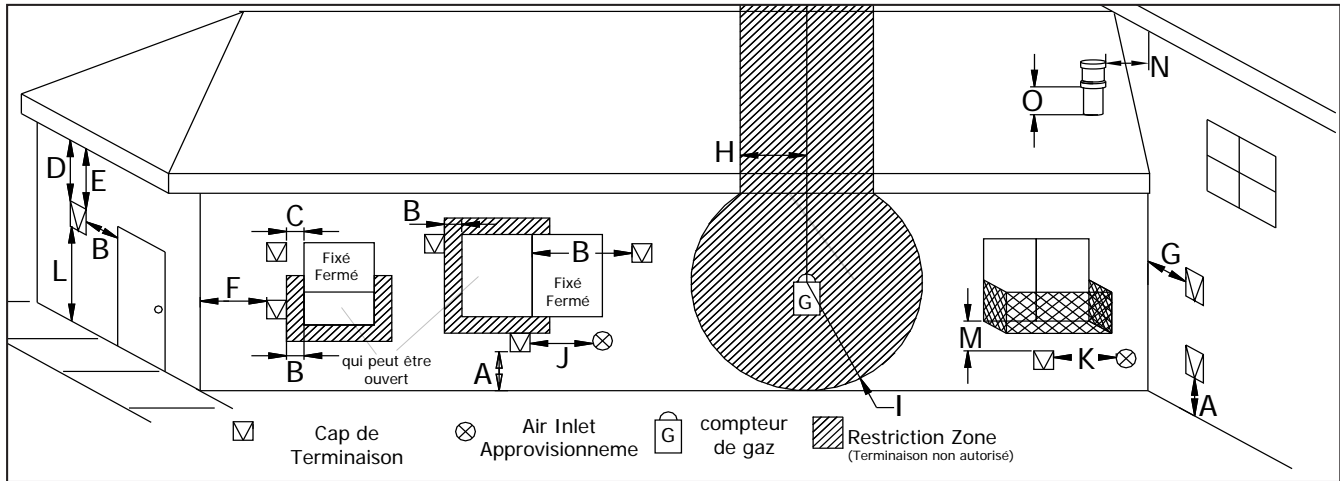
Restrictions sur les terminaisons des conduits, se référer au Tableau 4
